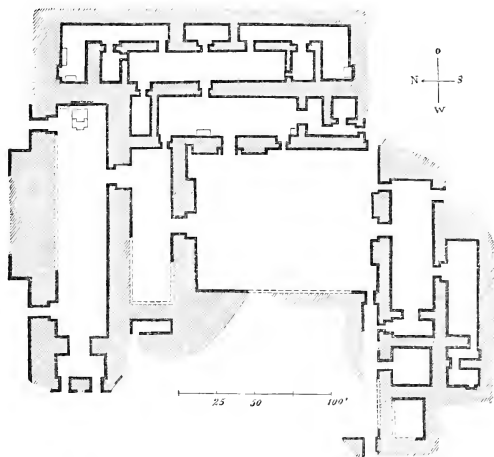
Grundriss des sogen. Nordwestpalastes zu Nimrud. (Nach Layard.)
